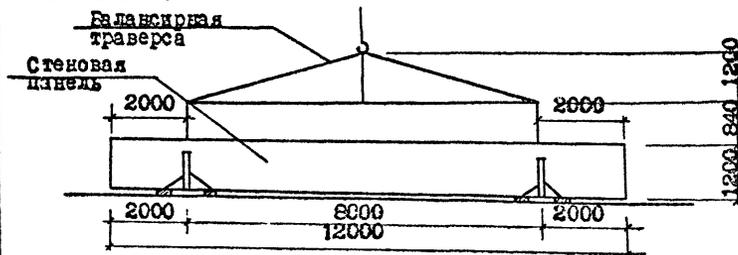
Строповка стеновой панели при разгрузке и монтаже.
